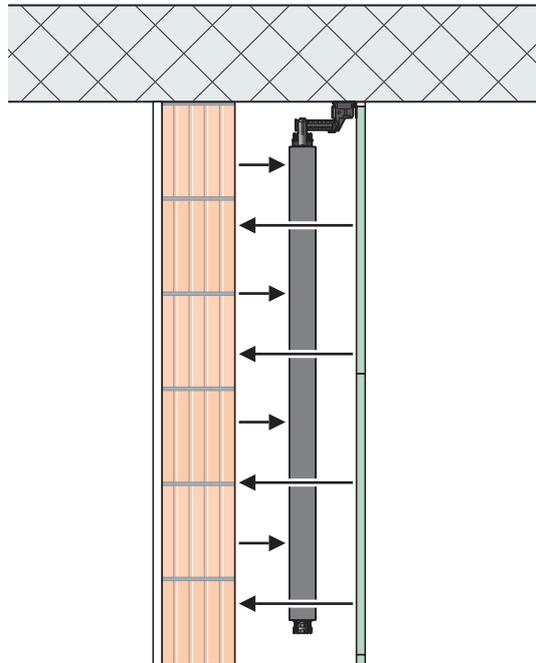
Verminderte Schallreflexion in einem Installationssystem mit schallabsorbierenden Geberit SilentPanel
